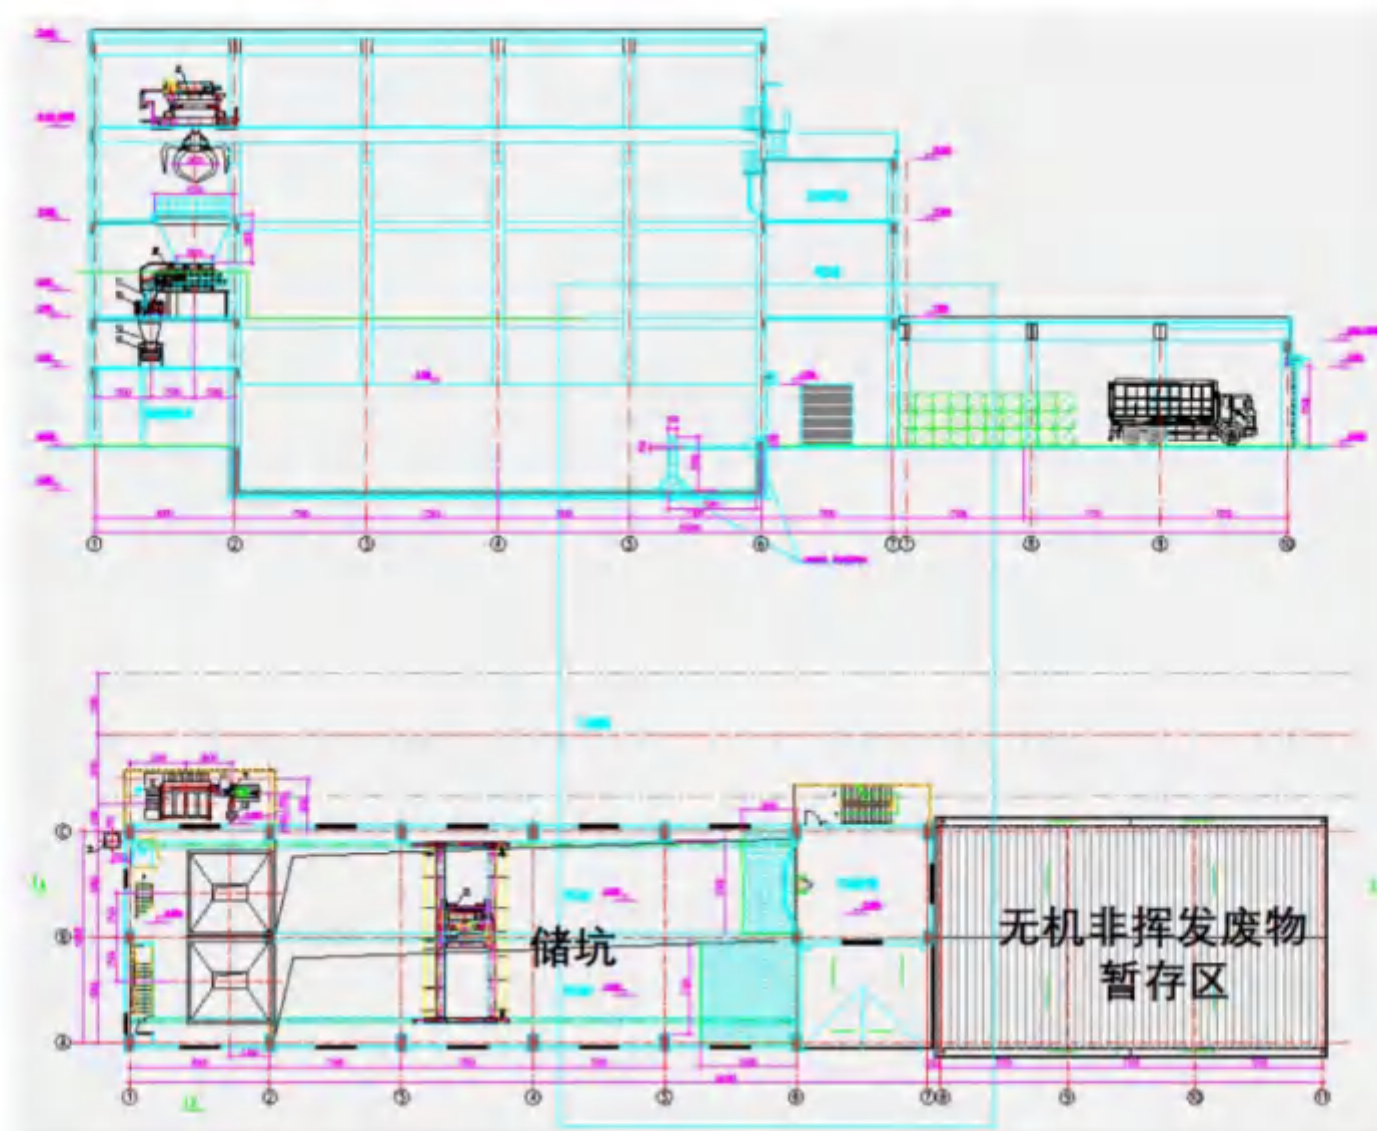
无机非挥发预处理车间平面布置图及立面图
